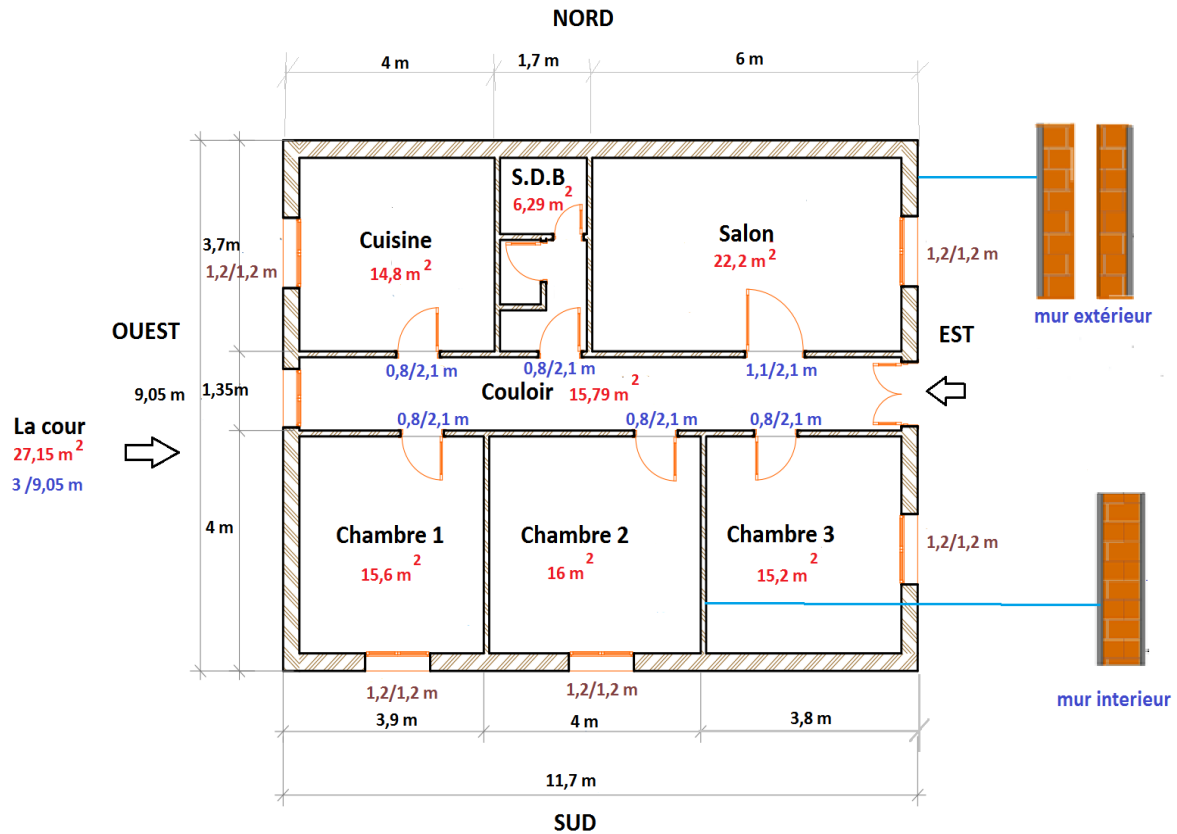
les composants des murs du bâtiment cas de base sur le Plan général
